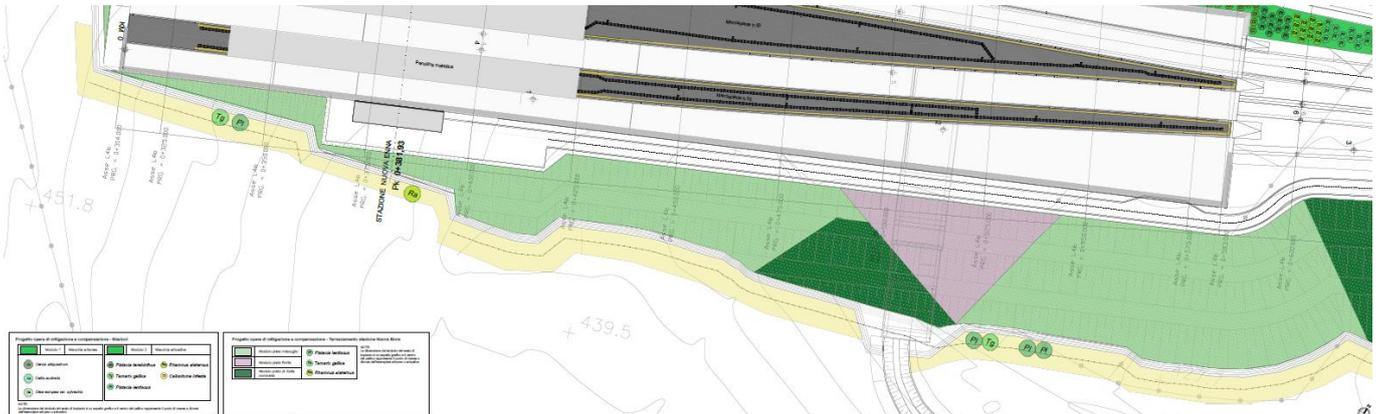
Progetto a verde rilevato stazione Nuova Enna
